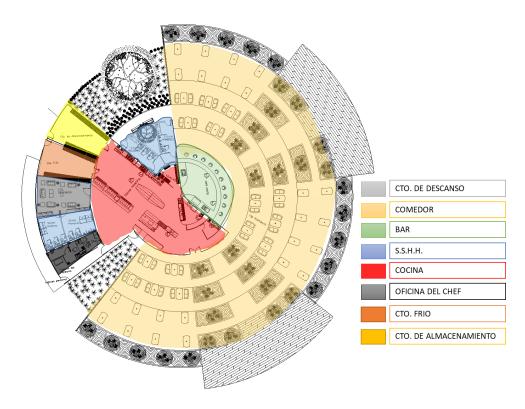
Plano Arquitectónico, Patio de Comidas
